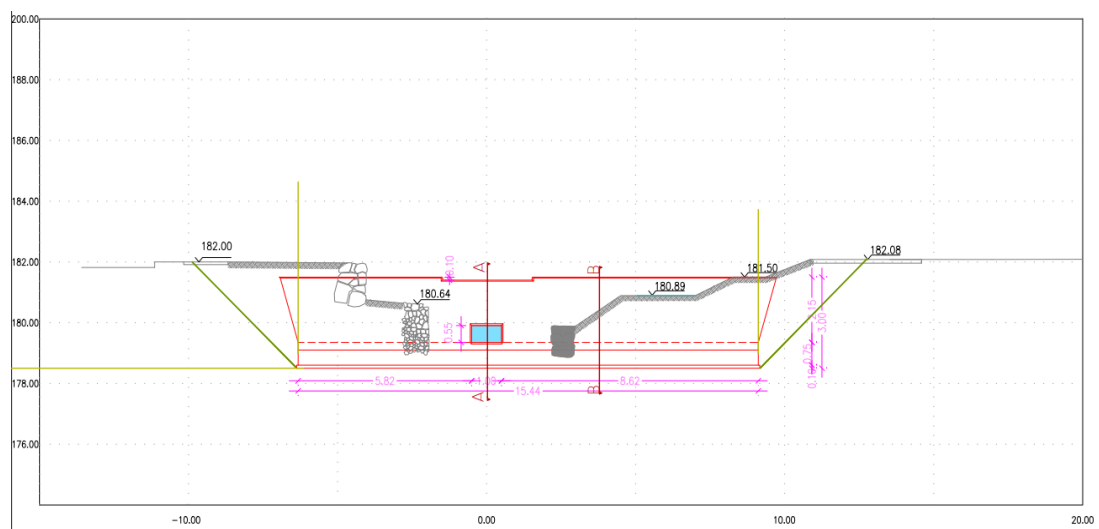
Alçado. Estrutura de retenção a Jusante. Fonte: Projegui.
